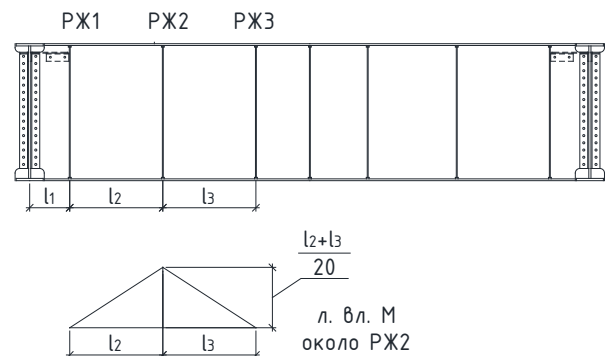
Линия влияния изгибающего момента в стенке балки на уровне верхнего обрыва сварного шва вертикального ребра жесткости
